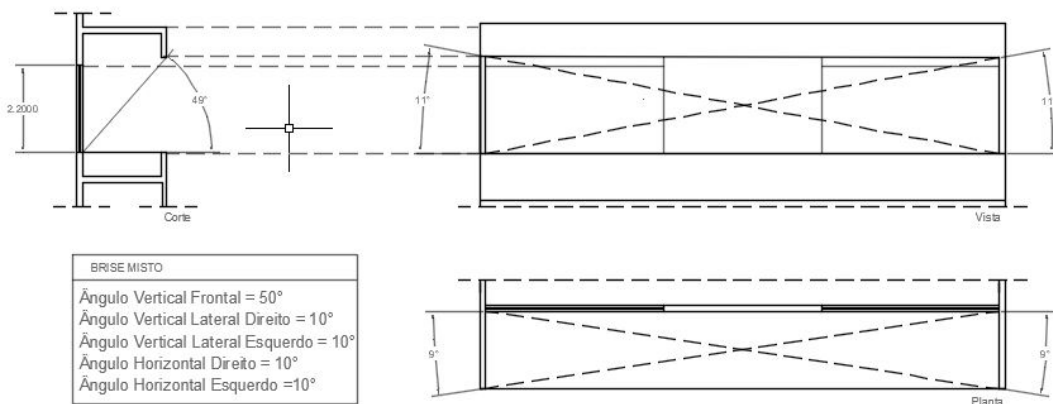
Fachada Noroeste - Ângulos da sala de Aplicação de Quimioterapia
